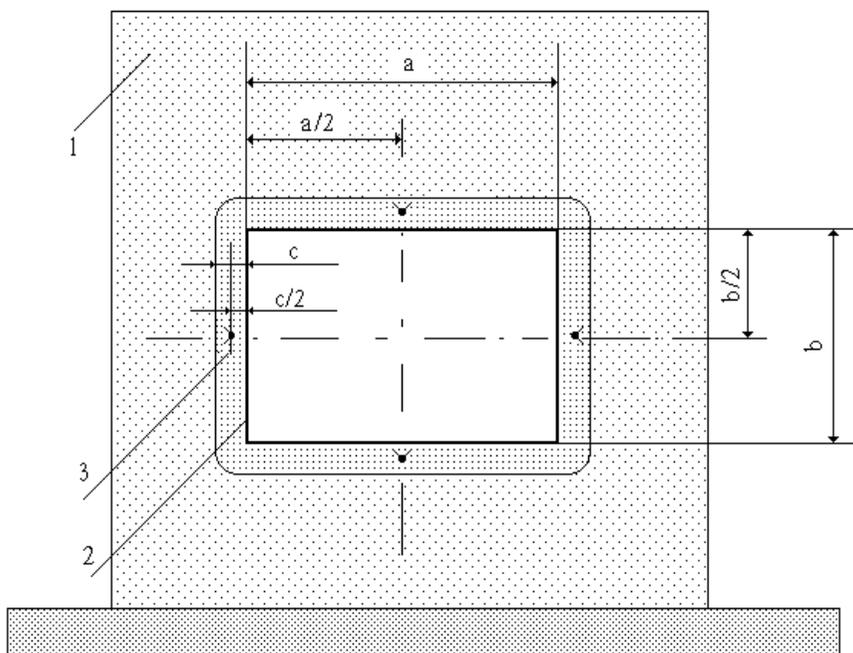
Схема размещения ТЭП в узле уплотнения места проходки воздухопровода через ограждающую конструкцию печи: 1 — печь; 2 — воздухопровод; 3 — уплотнение места проходки воздухопровода через ограждающую конструкцию печи; ▼ — ТЭП; a, b — внутренние размеры поперечного сечения воздухопровода; c — толщина заделки.
